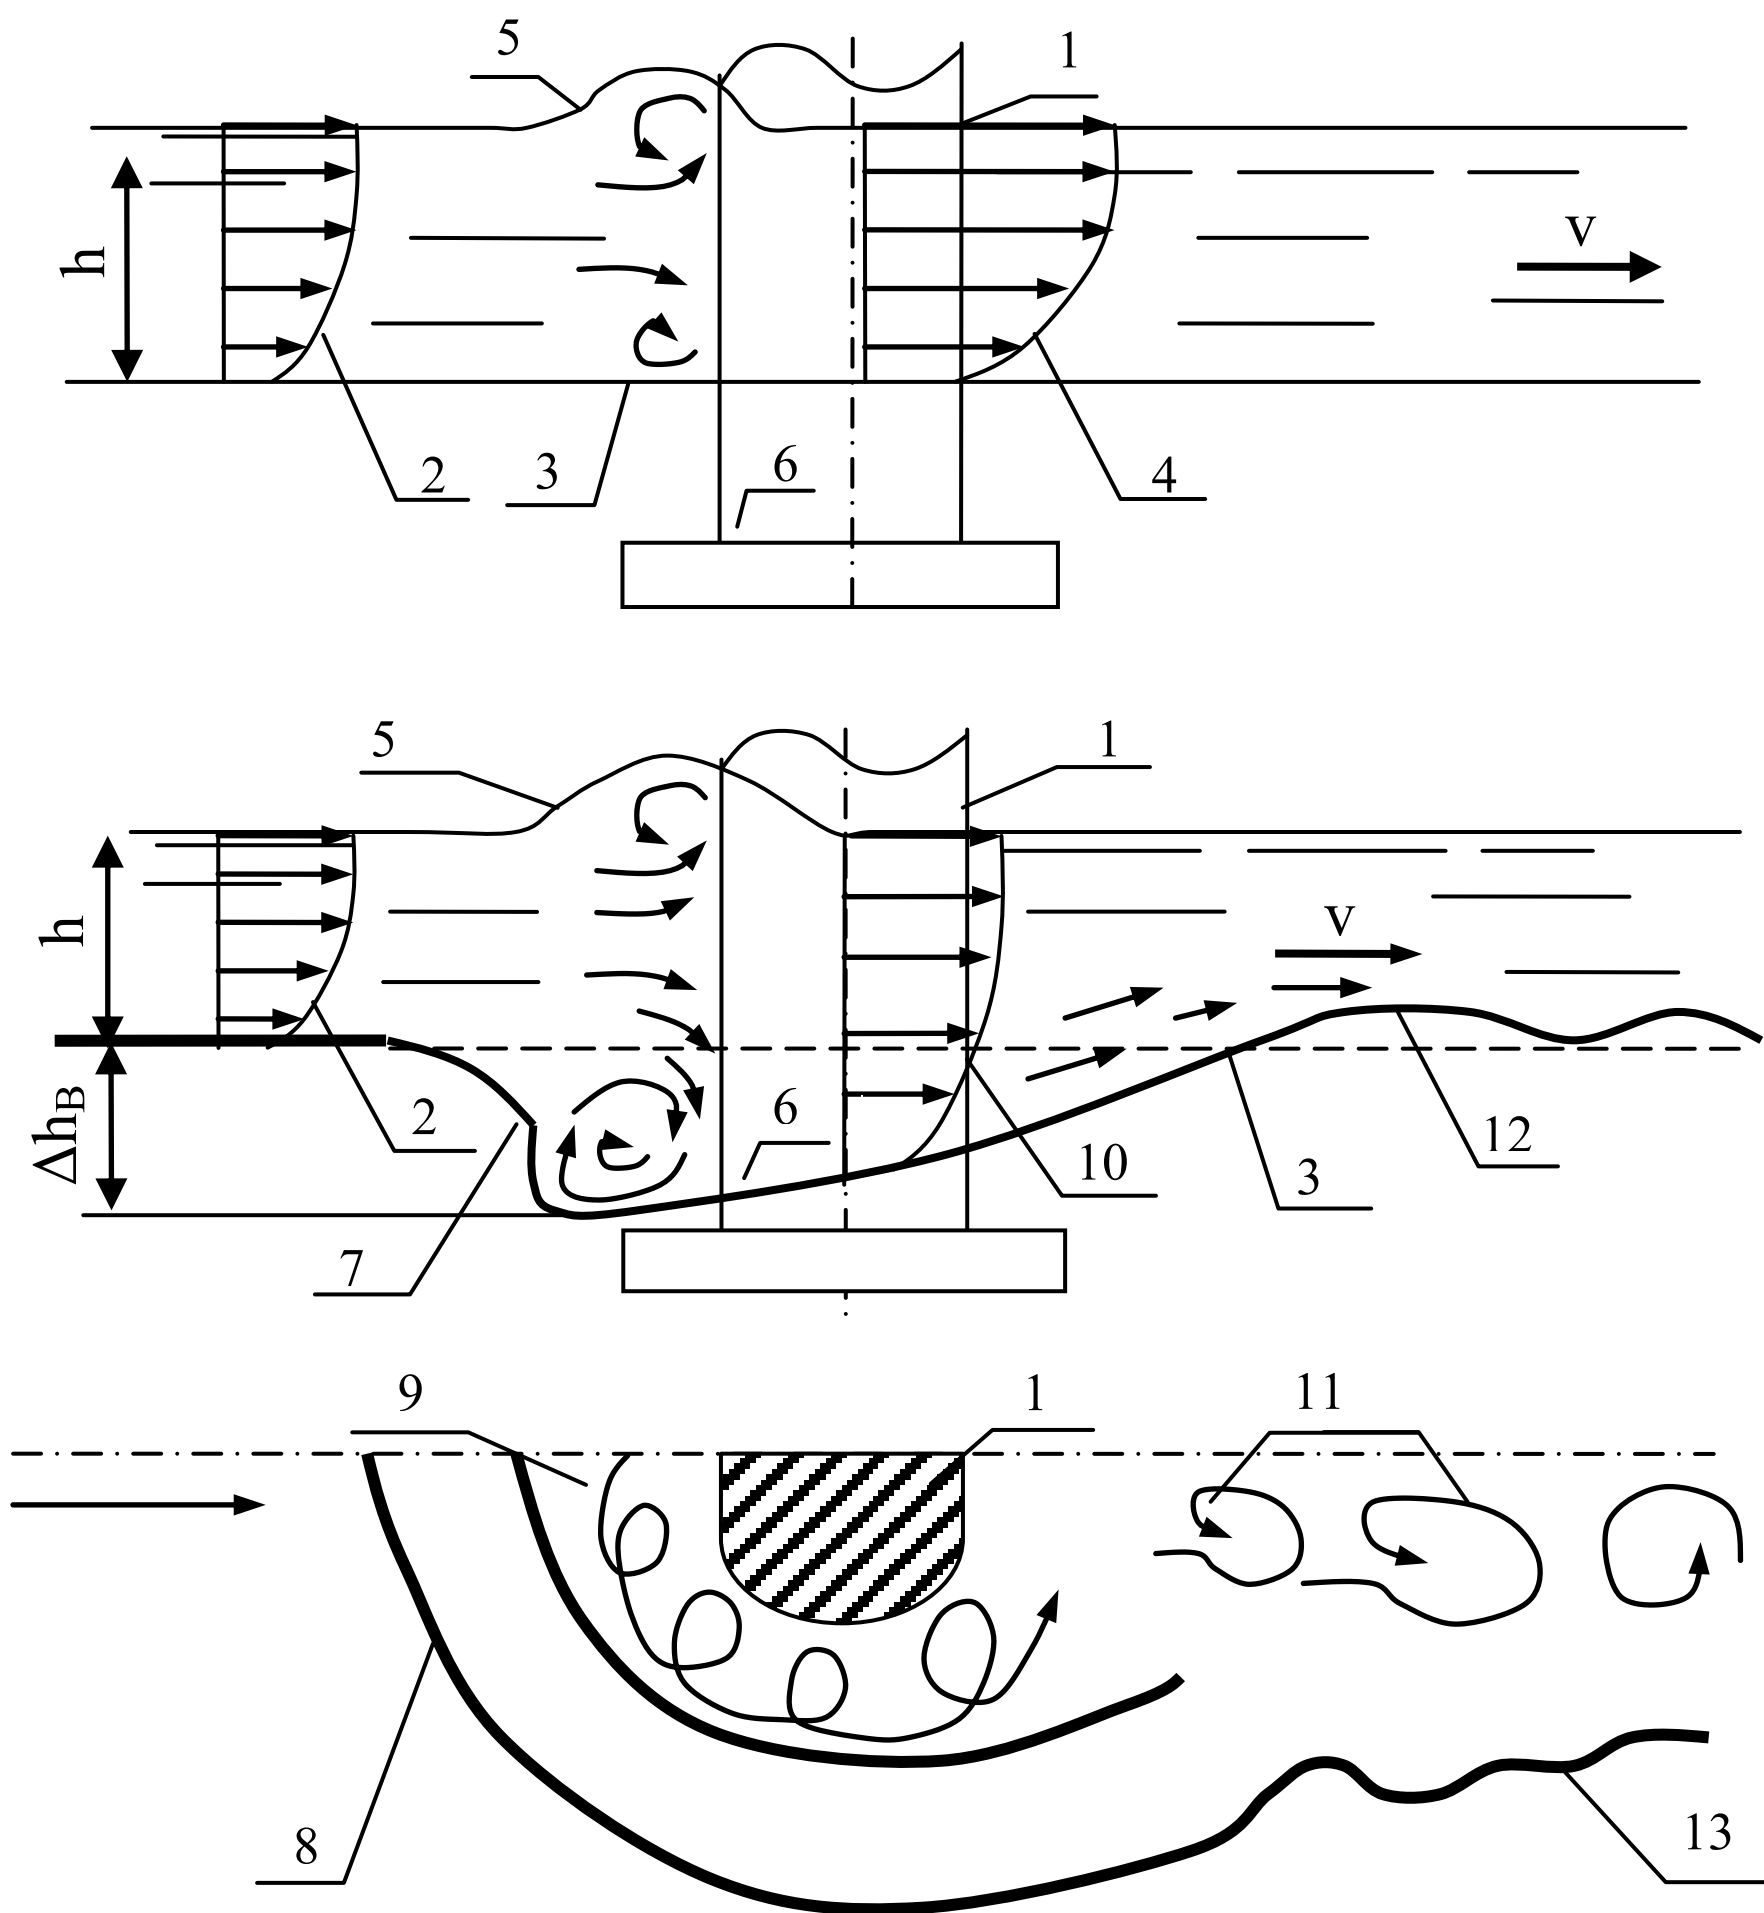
Схема образования воронки размыва около цилиндрической опоры:
